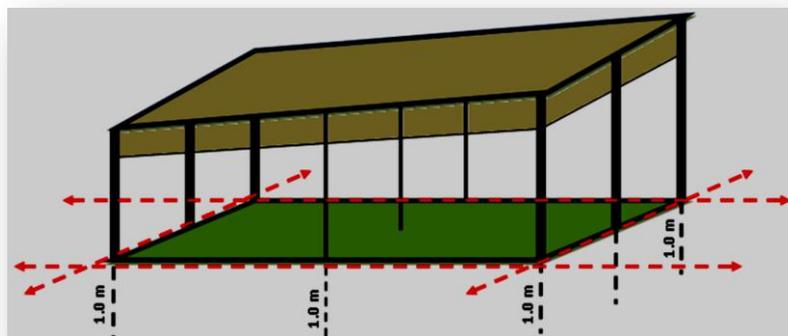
Vista en Planta de la parte enterrada de las cañas en el suelo
